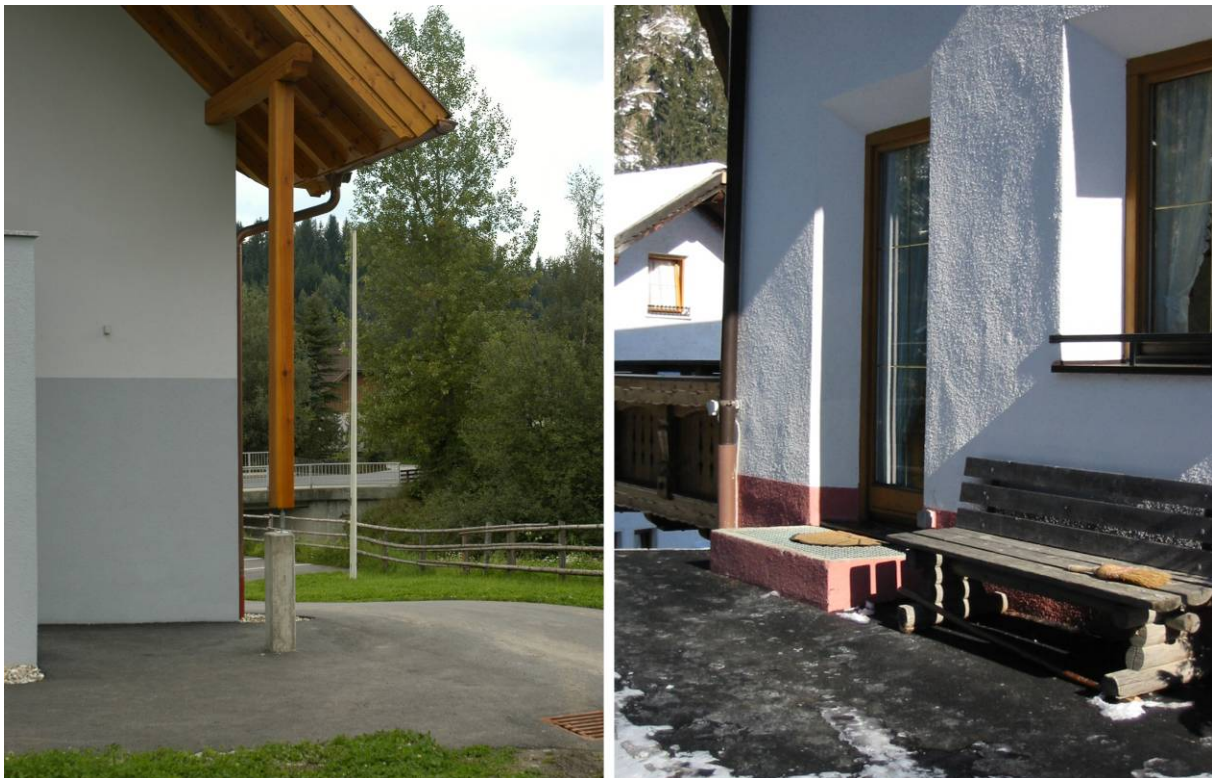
teilweise verstärkte Einbauten: (A) Im unteren Bereich in Stahlbeton ausgeführte Dachstütze; (B) im unteren Bereich mit Rohr verstärkte Dachrinne (Quelle A: Inst. für alpine Naturgefahren, BOKU; Quelle B: die.wildbach); aus [13]
